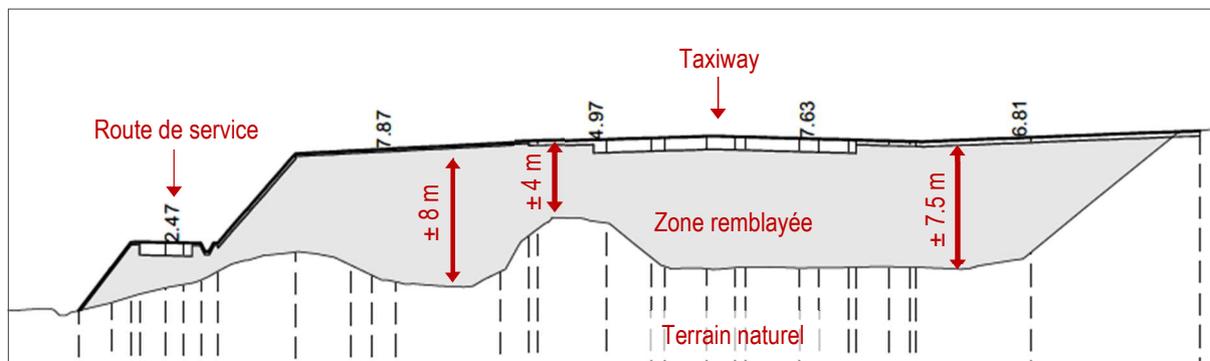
Coupe H (ARIES sur fond GREISCH, 2020)
